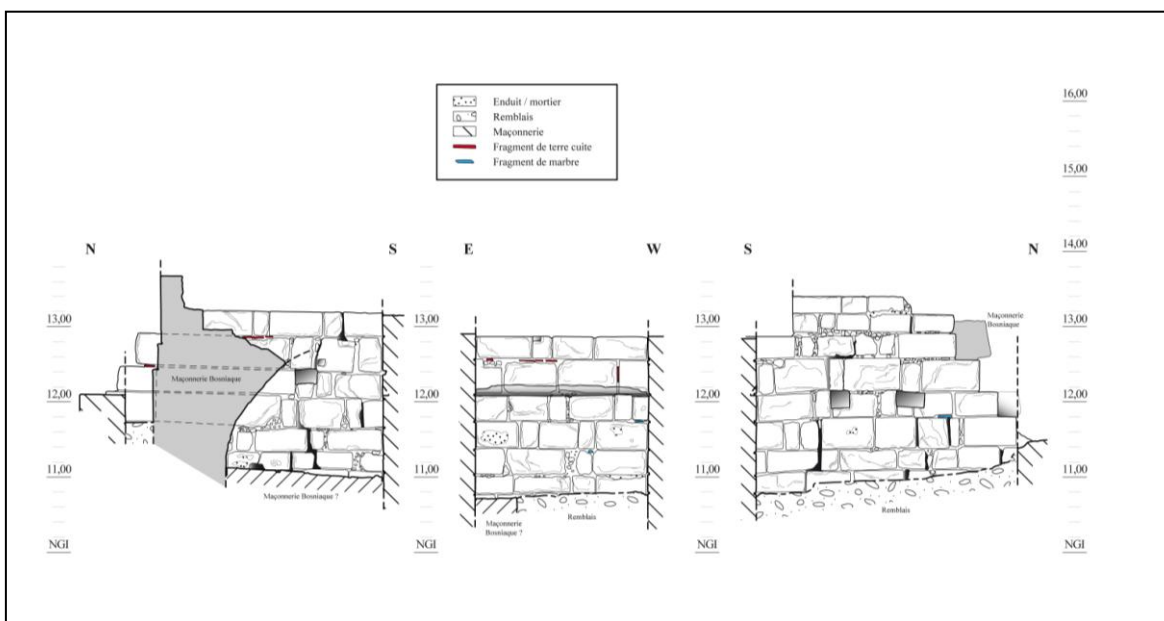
Elévations pierre à pierre des trois faces de la salle basse de la tour T13-Ouest (dessin F.Sanz-Pascual)
